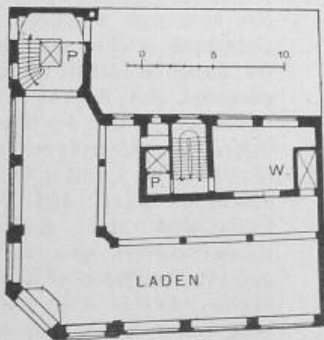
Erdgeschoss-Grundriss. 1:500.
